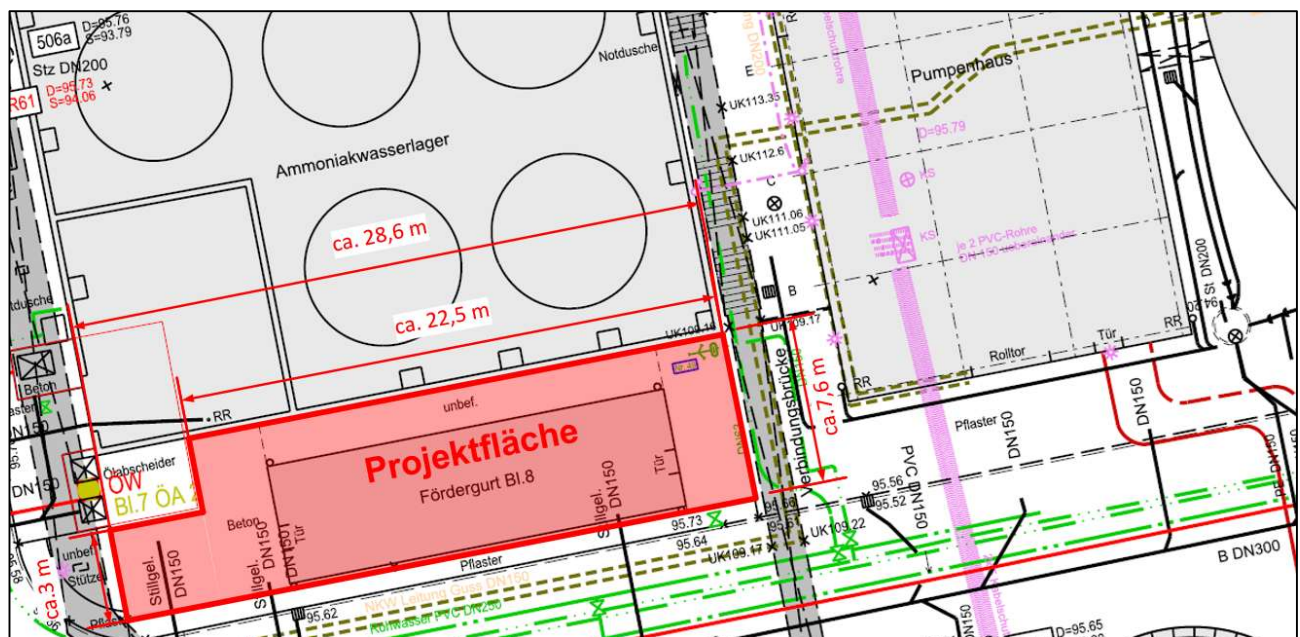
Lageplan mit angrenzenden Gebäuden und ungefähren Abmessungen
